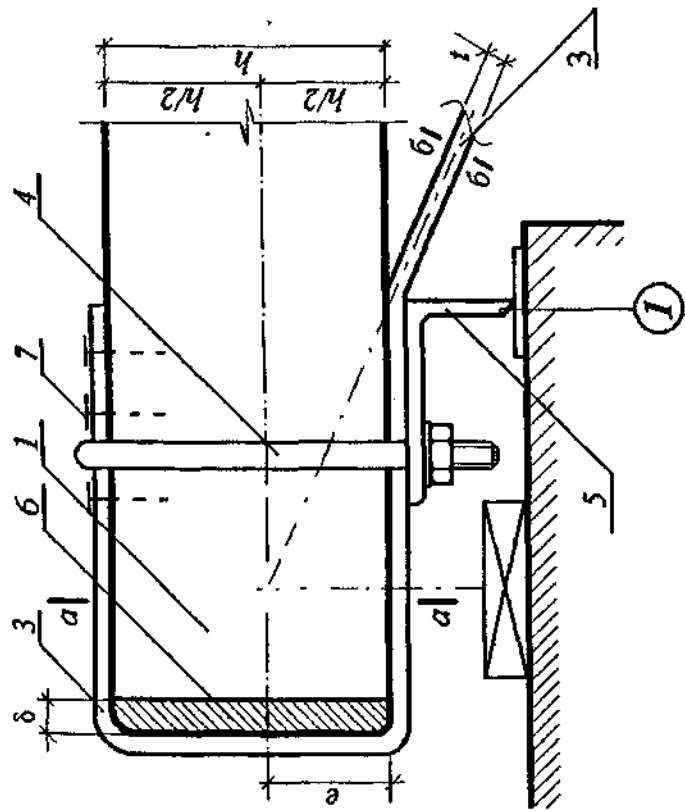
Опорный узел новой металлодеревянной шпренгельной балки. 1- верхний пояс; 3- шпренгель из полосовой стали; 4- скоба; 5- планка; 6- жесткий штамп; 7- нагели.
